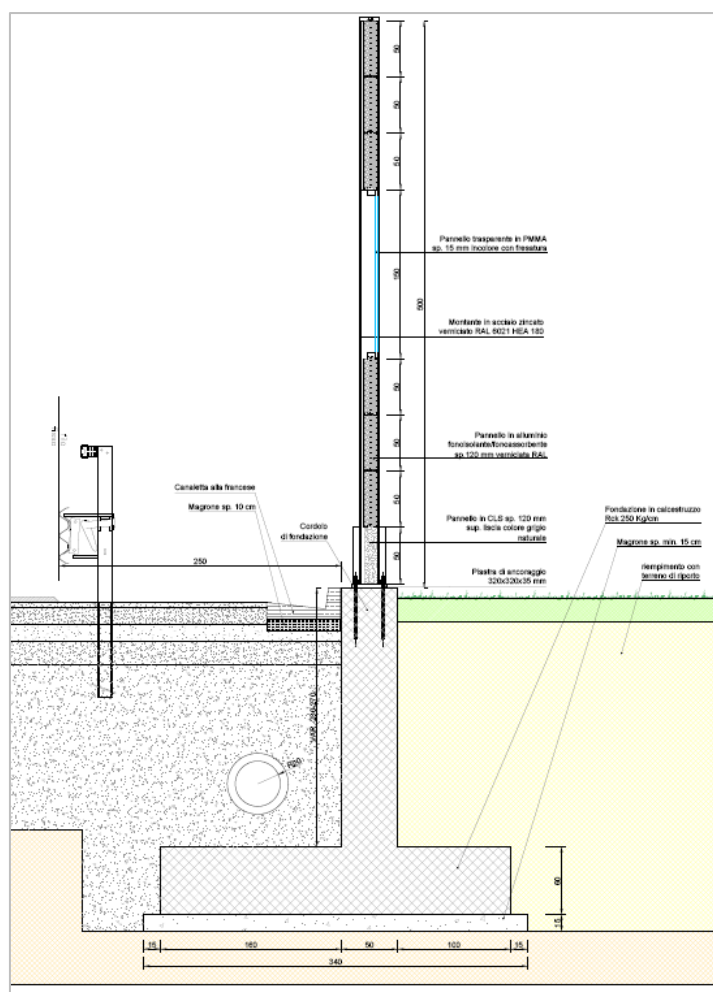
MURO BARRIERA CON FONDAZIONE SU TERRENO IN SITU
